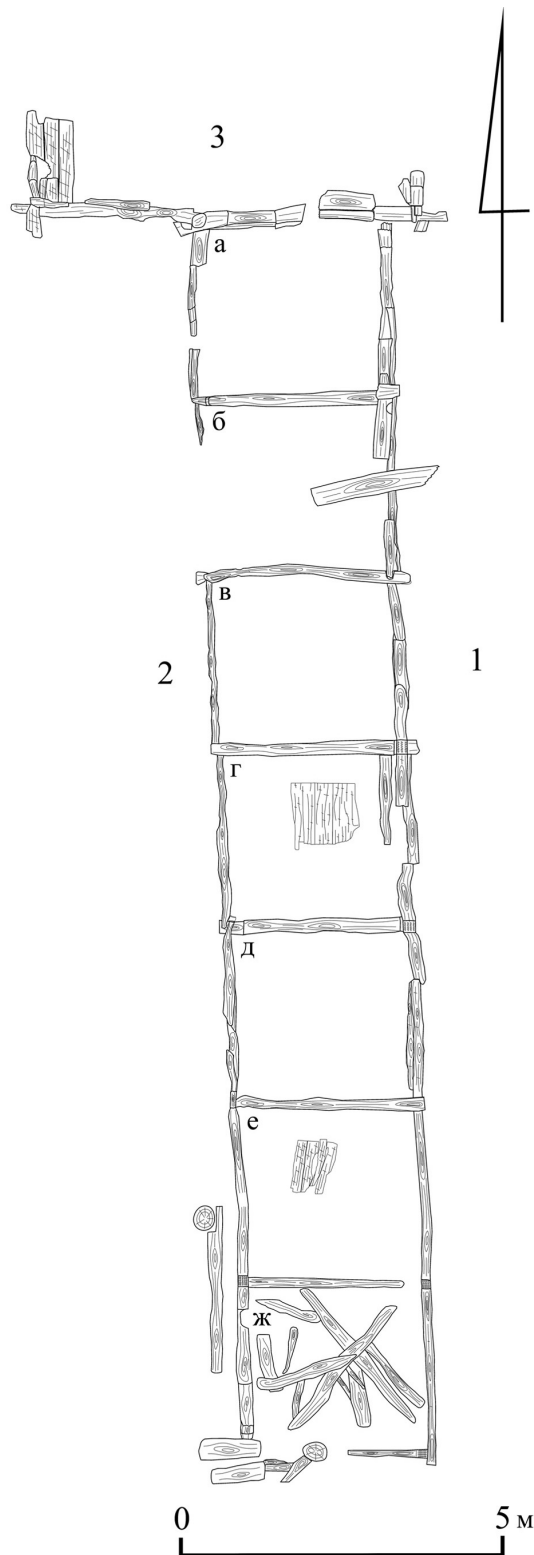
План западной тарасной стены Удинского острога: 1 – внутренняя стена; 2 – внешняя стена; 3 – остатки северо-западной угловой башни; а–ж – камеры
